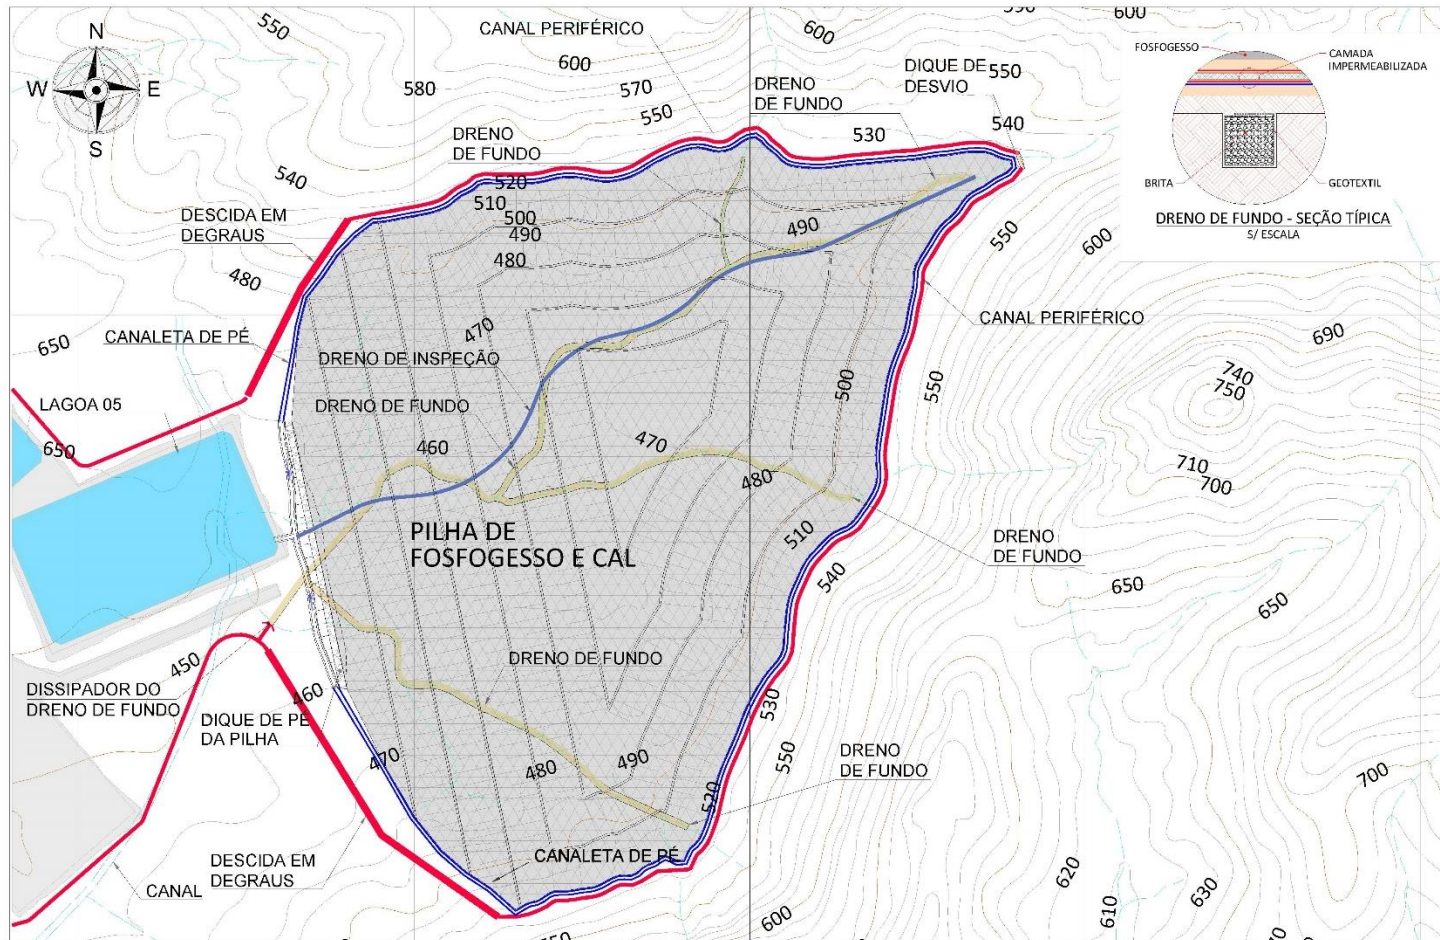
Planta da Pilha de Fosfogesso e cal, traçados dos drenos de fundo e de inspeção, e seção transversal típica do dreno de fundo.
